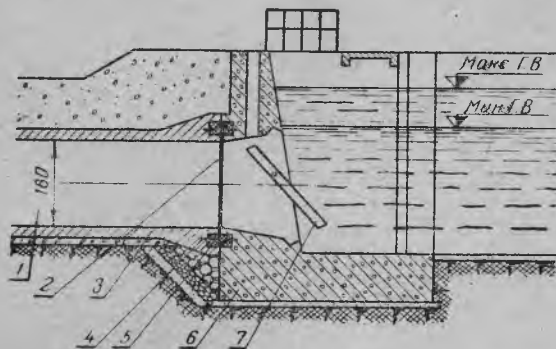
Присоединение монолитного железобетонного трубопровода к напорному бассейну:
